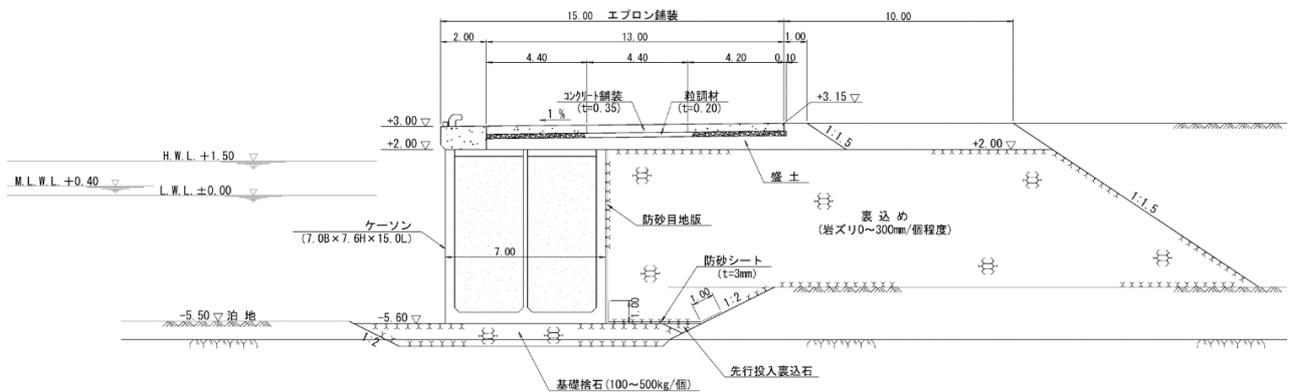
No.17 常陸那珂港区_北埠頭地区岸壁 (-5.5m) G、H の断面図 (被災前)
